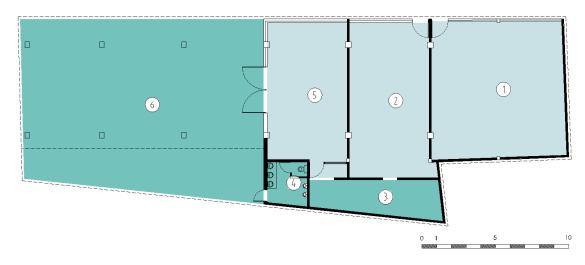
Planta primer nivel Bloque No.33 Fuente: Equipo Diagnóstico.
